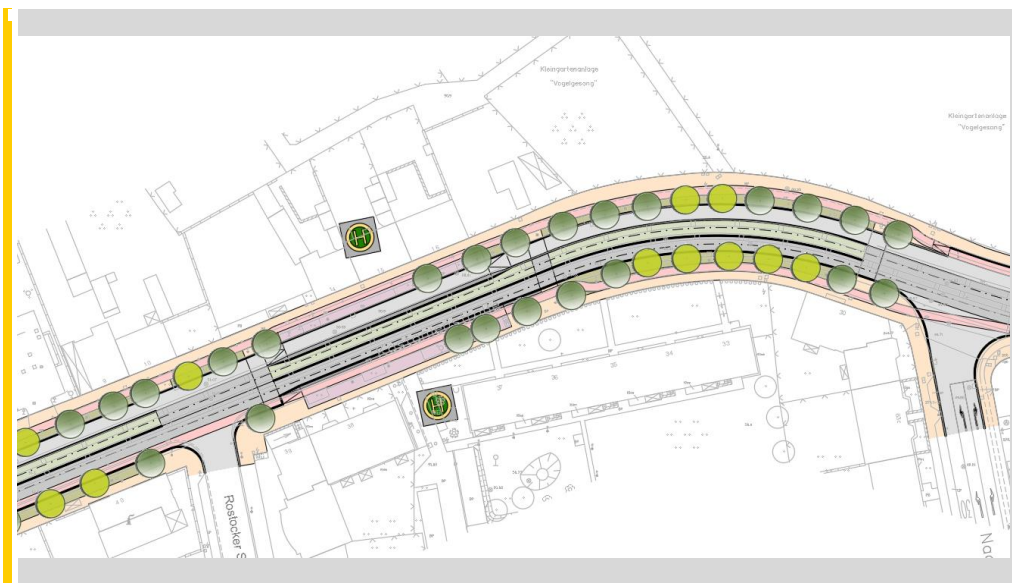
Kastanienstraße, Lageplanausschnitt V2
